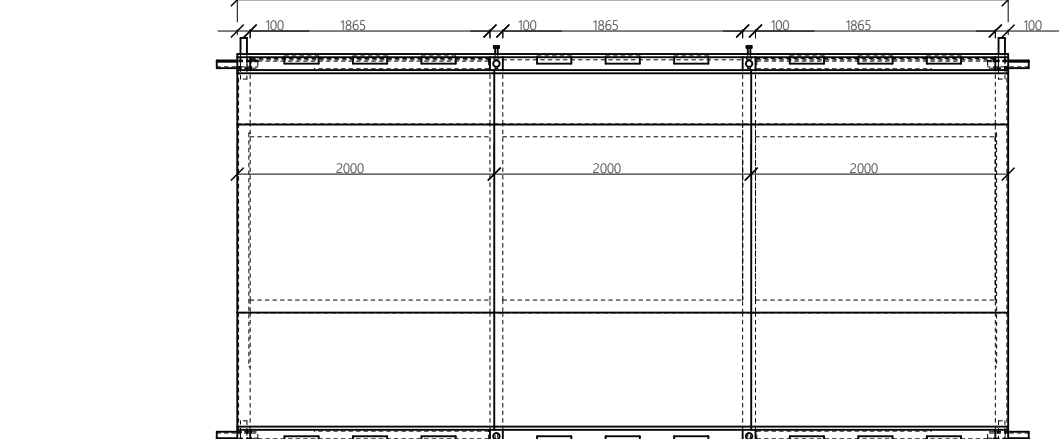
MODULÁRNA ARCHITECTÚRA
